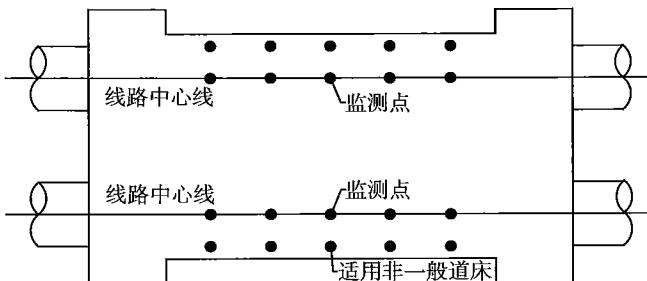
地下车站或框架隧道竖向位移监测点平面布置示意图
